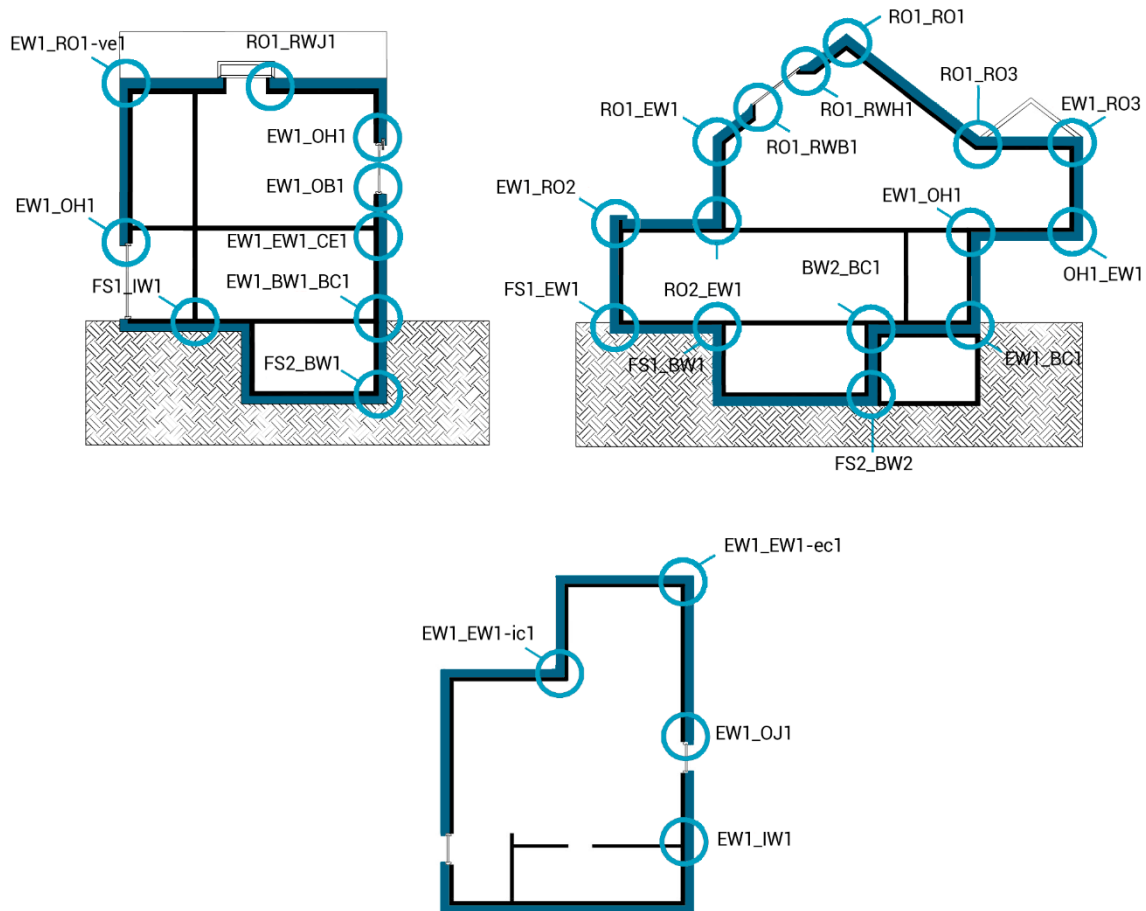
Detalles constructivos evaluables en el estándar Passivhaus para componentes constructivos opacos. Fuente: Passivhaus Institut
